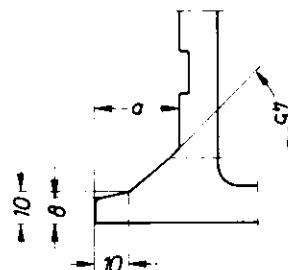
Fußleiste der Deckenziegel für Stahlbetonrippendecken
